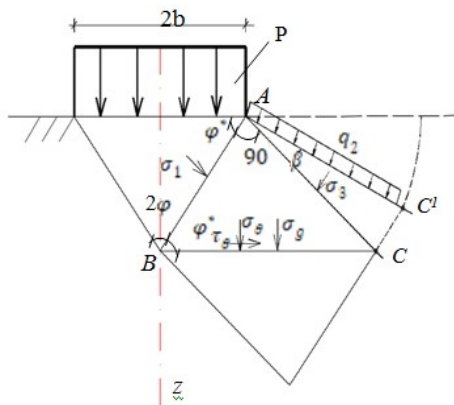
Расчетная схема для определения предельной критической нагрузки на грунт
